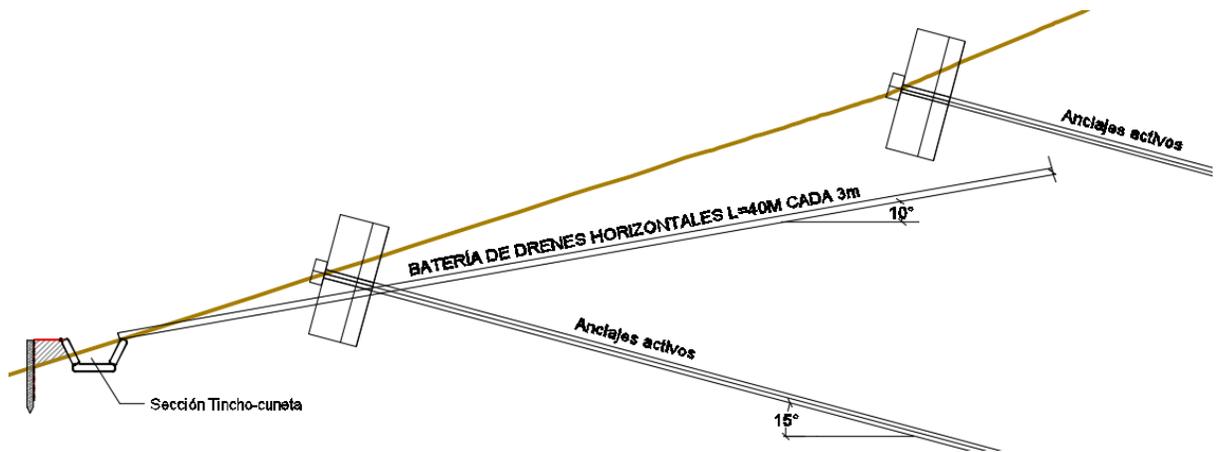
Vista lateral obras k2+430. Fuente: Diseños UT CONSULVIALES
